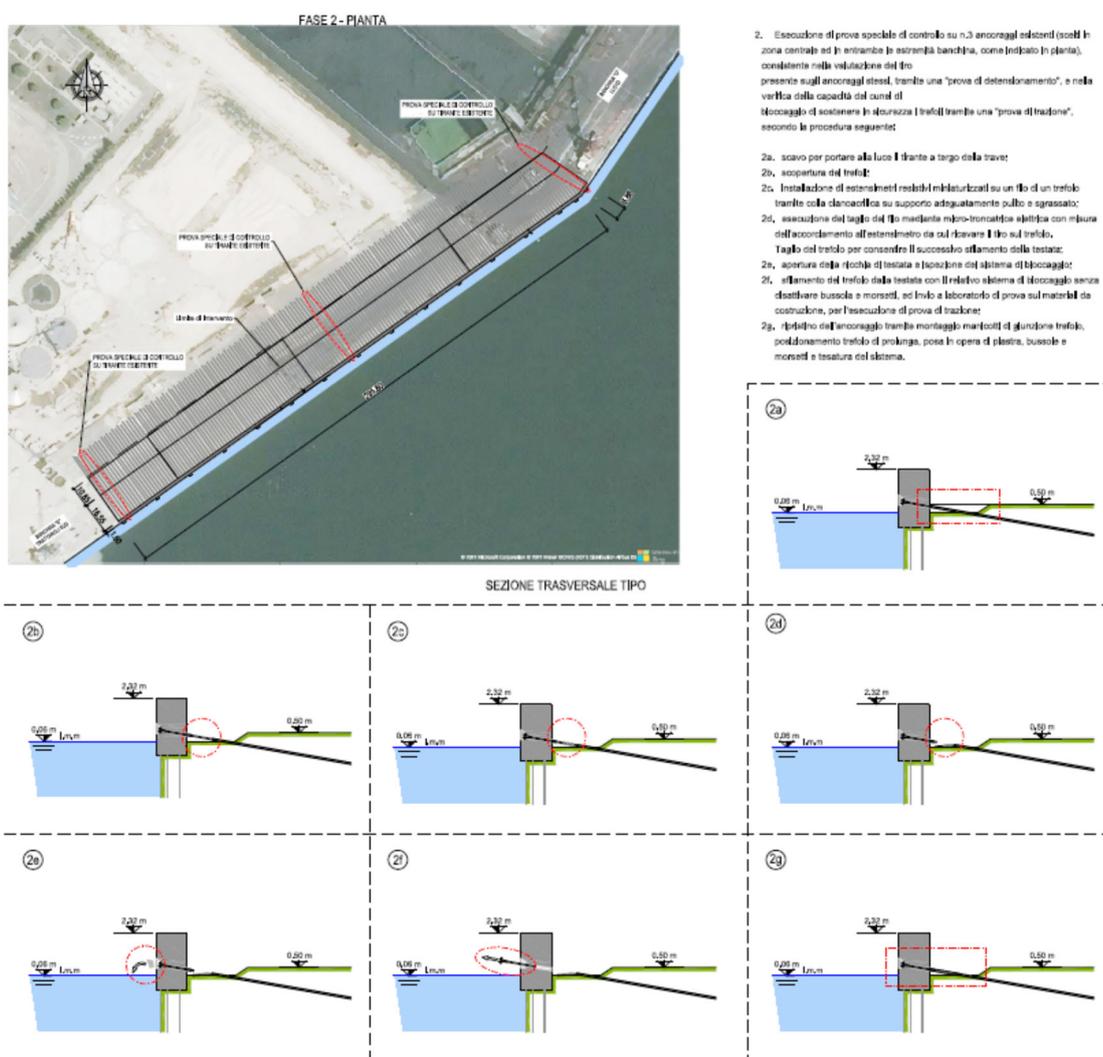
Banchina Trattaroli Nord – Fase 2 – Sezione e planimetria
